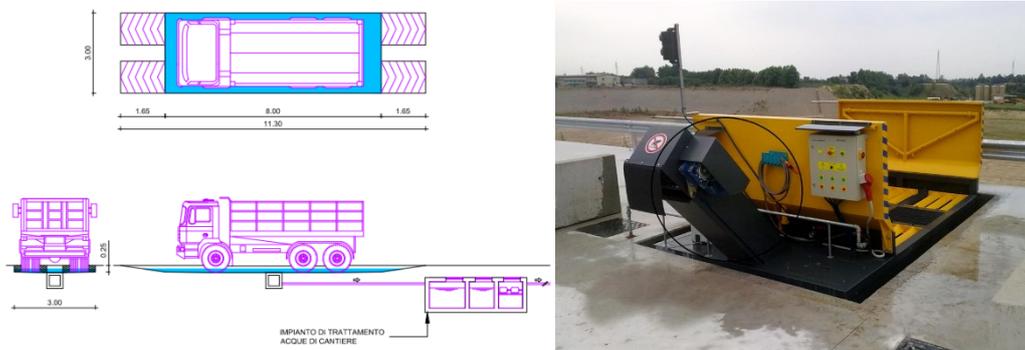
Impianto di lavaggio mezzi tipo A nei cantieri fissi
